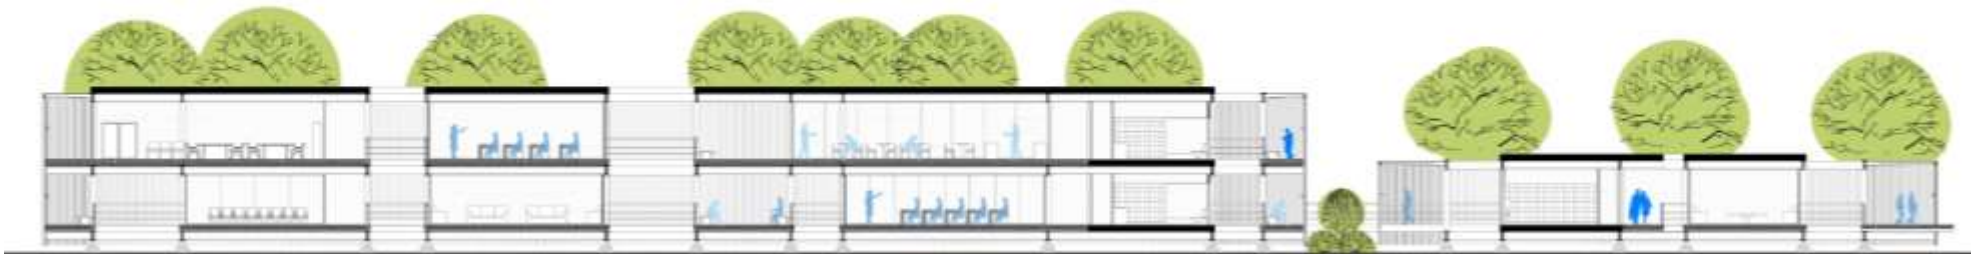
Planos de Elevaciones C y D. Fuente: Elaboración Propia. Esc. 300
